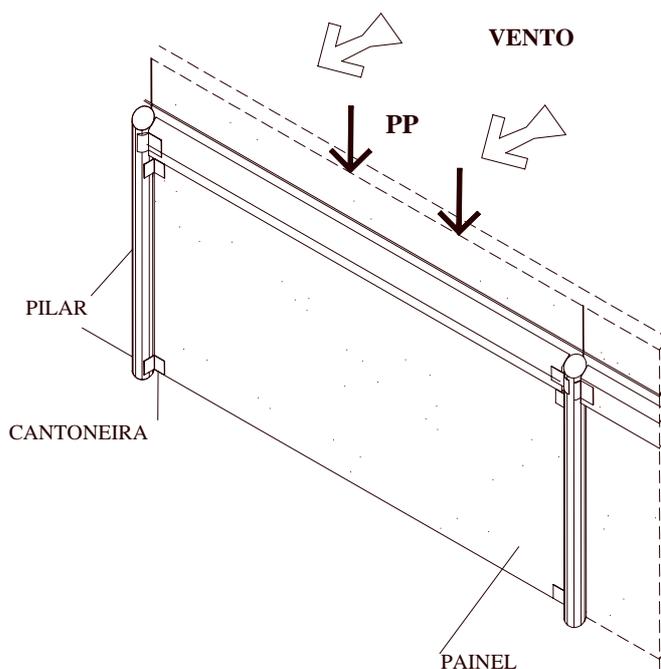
Perspectiva do painel cortina com fixação no pilar.
